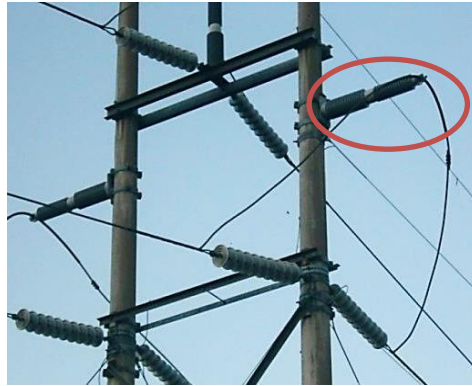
Aislador de barra larga, estructura dentro de la subestación San Bartolo.⁴⁵
